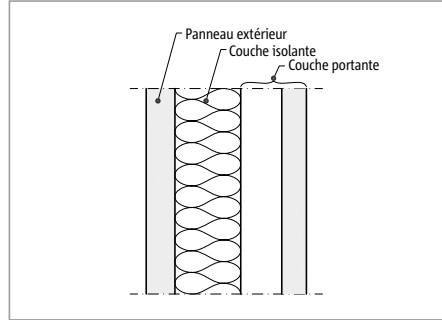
Coupe à travers un mur préfabriqué ; couche portante avec complément en béton coulé sur place
